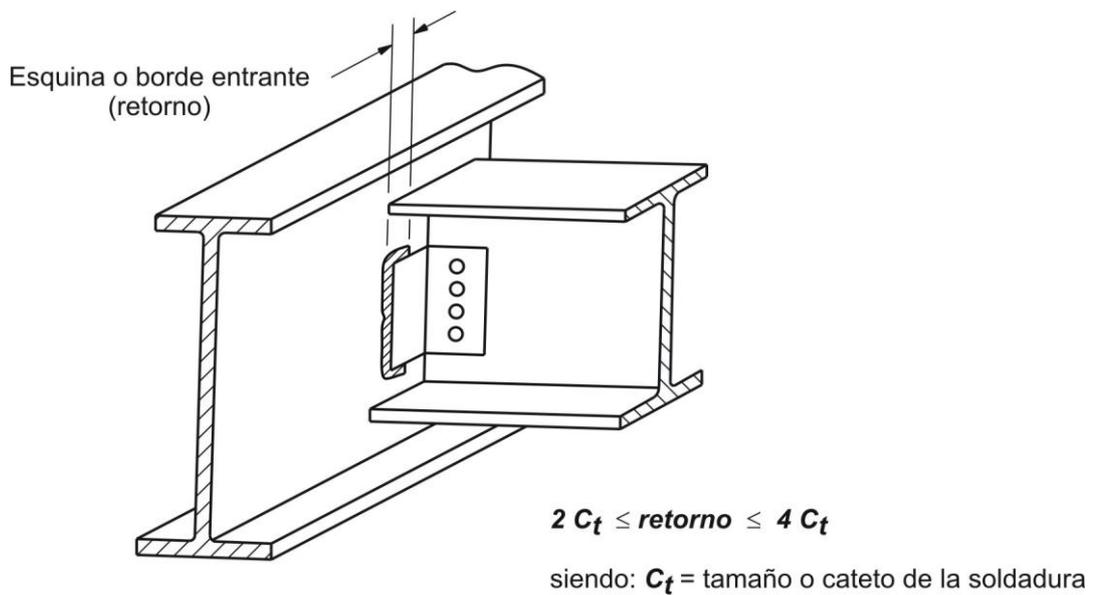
Esquinas entrantes o con retorno en uniones flexibles de elementos estructurales.
